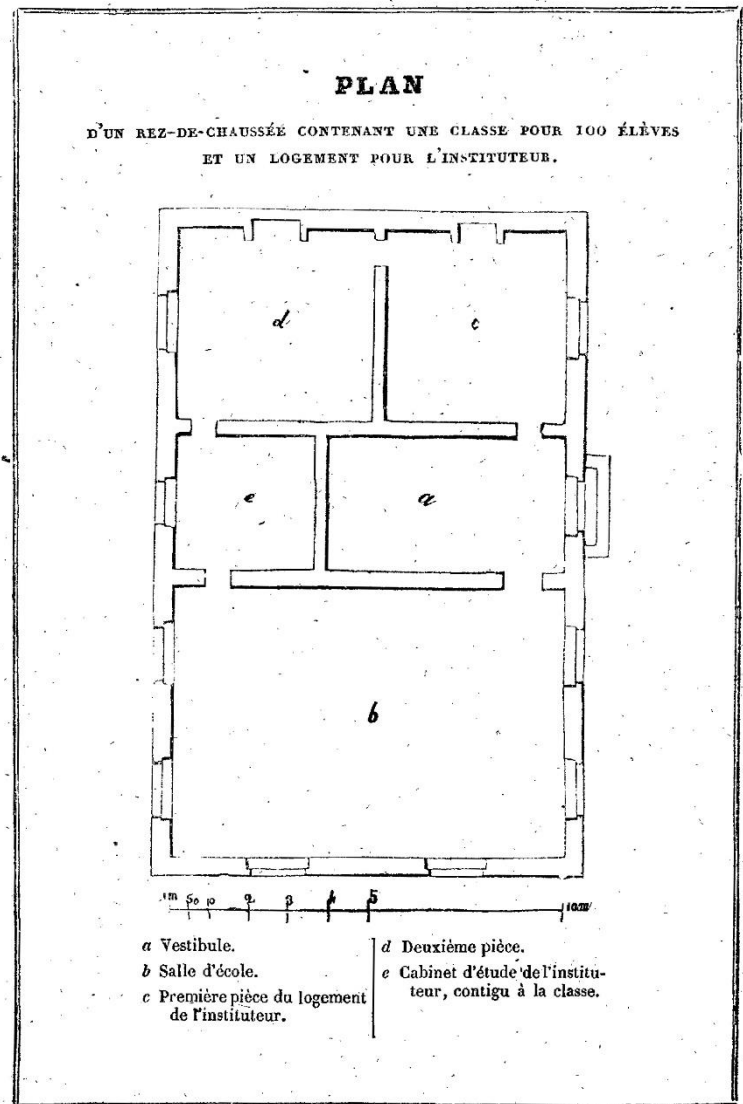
Plan d'un rez-de-chaussée contenant une classe pour 100 élèves et un logement pour l'instituteur. Plan détaillé de la salle de classe pour 100 élèves. In *Code de l'instruction primaire contenant l'histoire de la législation primaire depuis 1783, la loi du 28 juin 1833, l'ordonnance du roi du 16 juillet 1833, les circulaires et instructions ministérielles pour l'exécution de la loi* (2<sup>e</sup> édition). Paris : P. Dupont, 1834, modèle n° 11.
